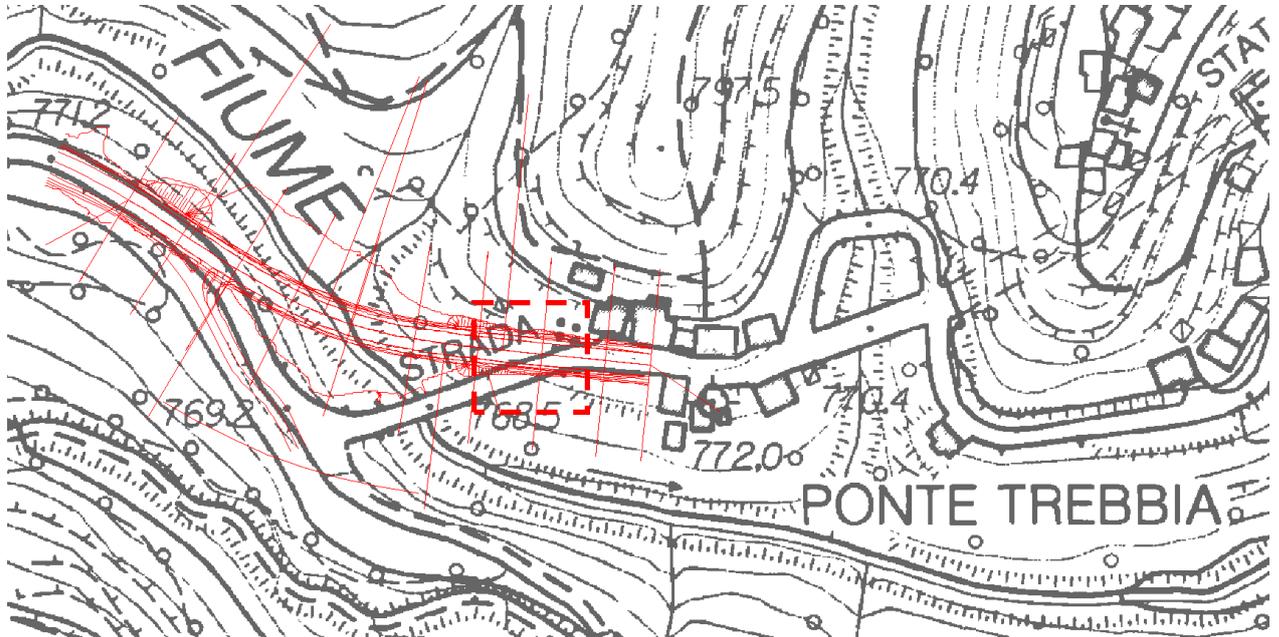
Fase di cantiere: Ubicazione lavorazioni critiche dettaglio
